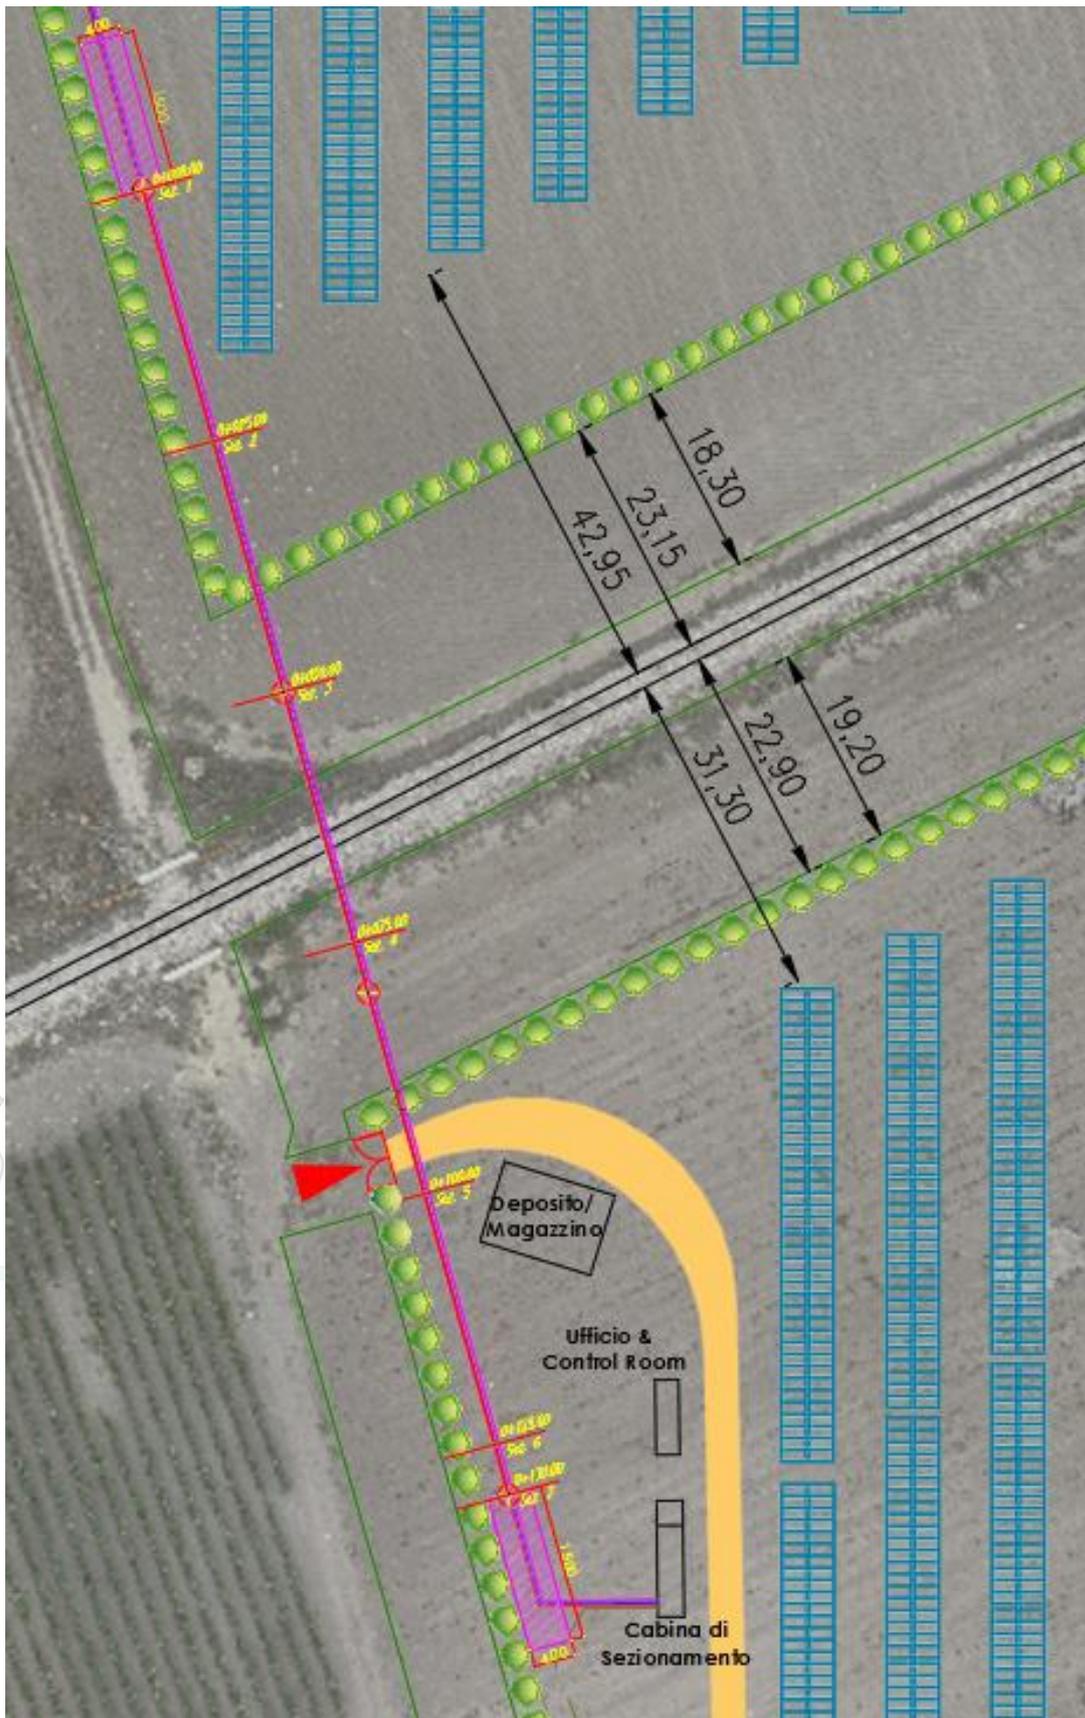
Particolare Attraversamento Planimetrico Rete Ferroviaria
